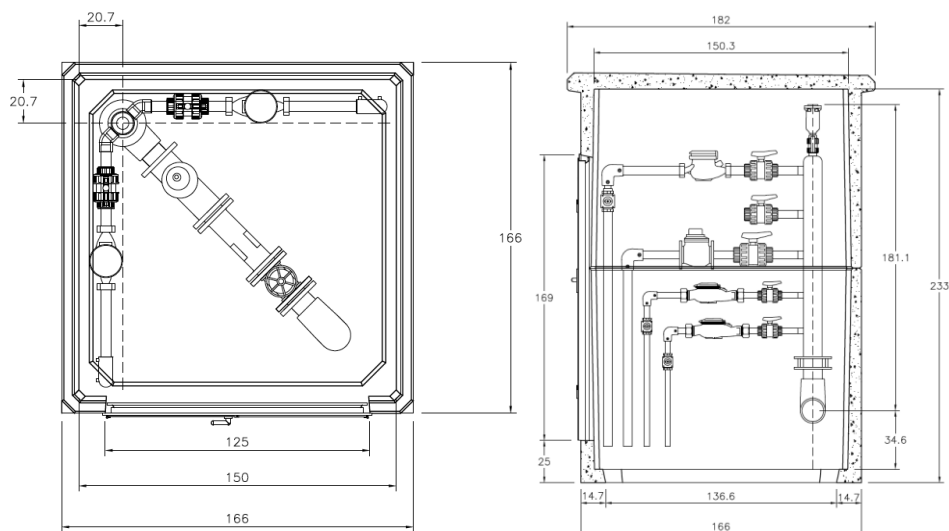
Secciones caseta recomendada hidrante tipo "Costella". Sección planta y lateral.
